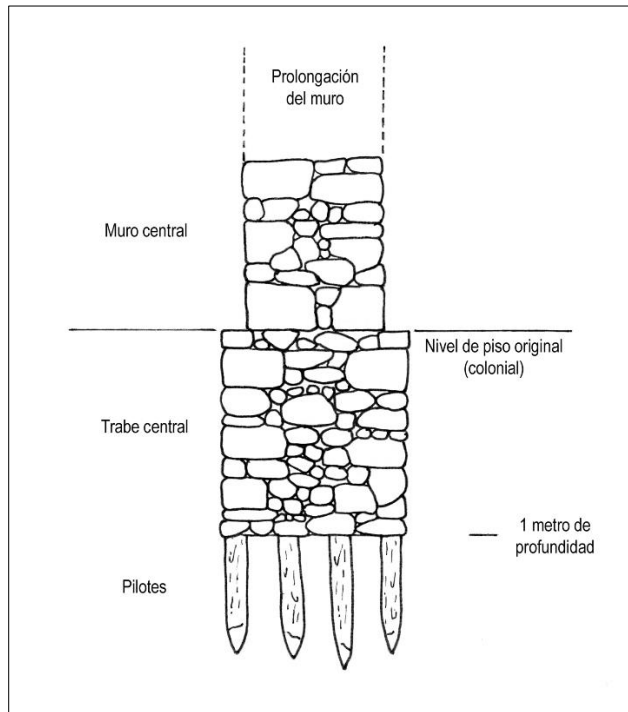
Corte reconstructivo transversal de la trabe central, muro y pilotes.
